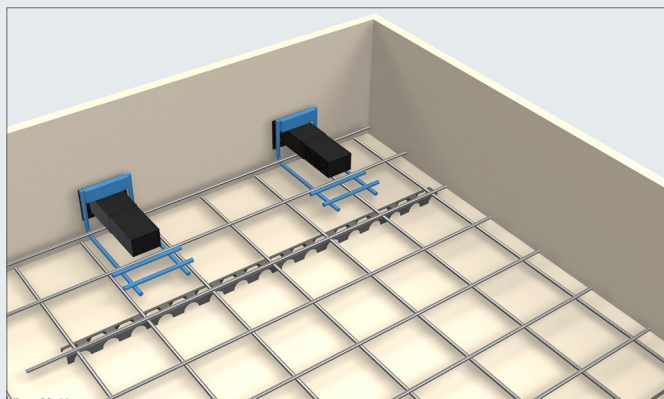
Монтаж гільзи з порталною арматурою в плиті сходового майданчика.
